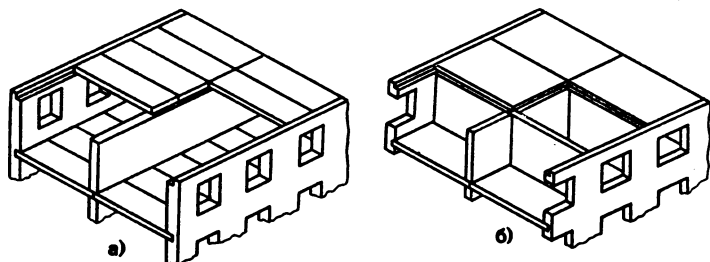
Конструктивные схемы бескаркасных зданий с несущими стенами: а — продольными, б — поперечными и продольными
